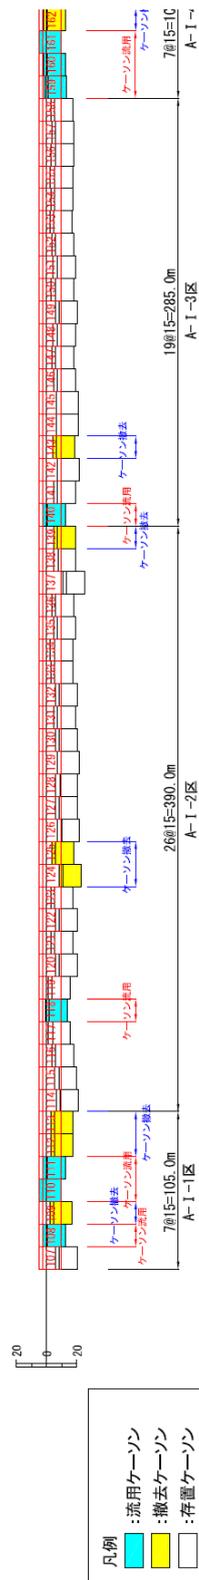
No.1 沖防波堤の断面図 A-I-1 区～A-I-3 区 (被災後・復旧後)
